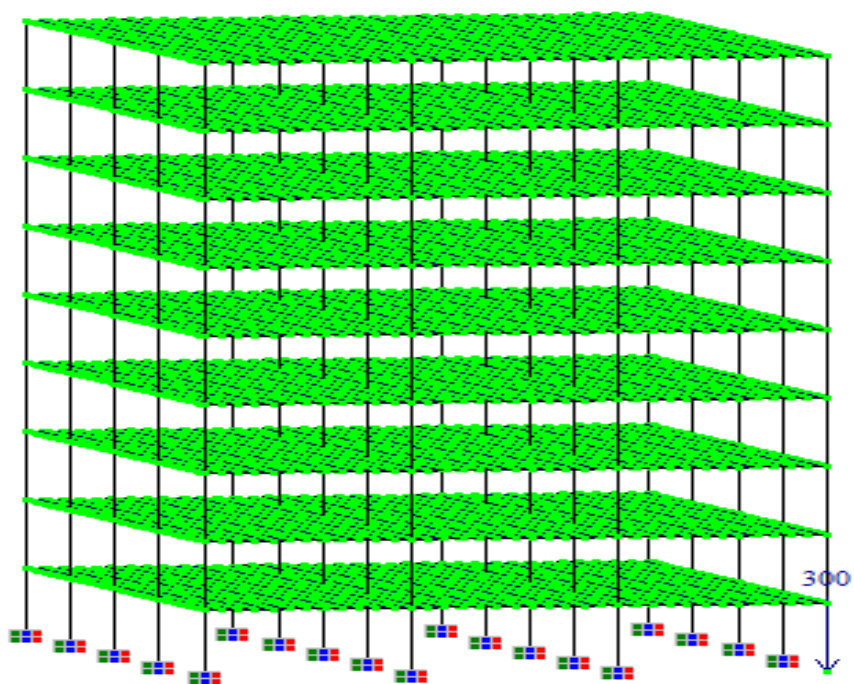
Schéma illustratif du modèle d'étude du Planchers en hourdis à 9 niveaux avec un chargement vertical sur le poteau d'angle
